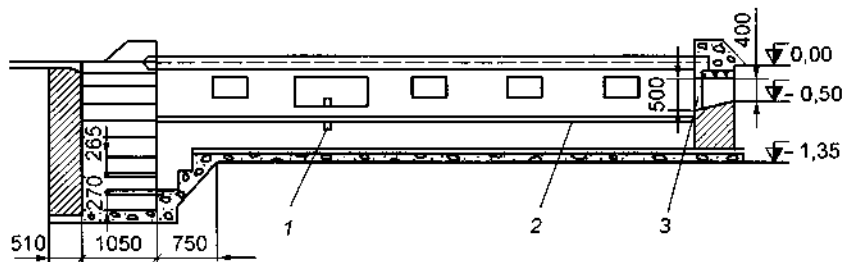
Смотровая канава в разрезе: 1 — маслопровод; 2 — борозда для электропроводки; 3 — вентиляционный канал
